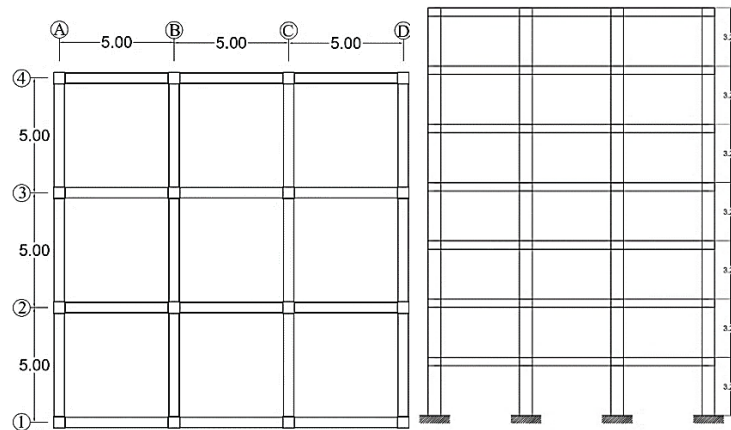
Estructura aporticada de mediana altura (vista en planta y elevación)
